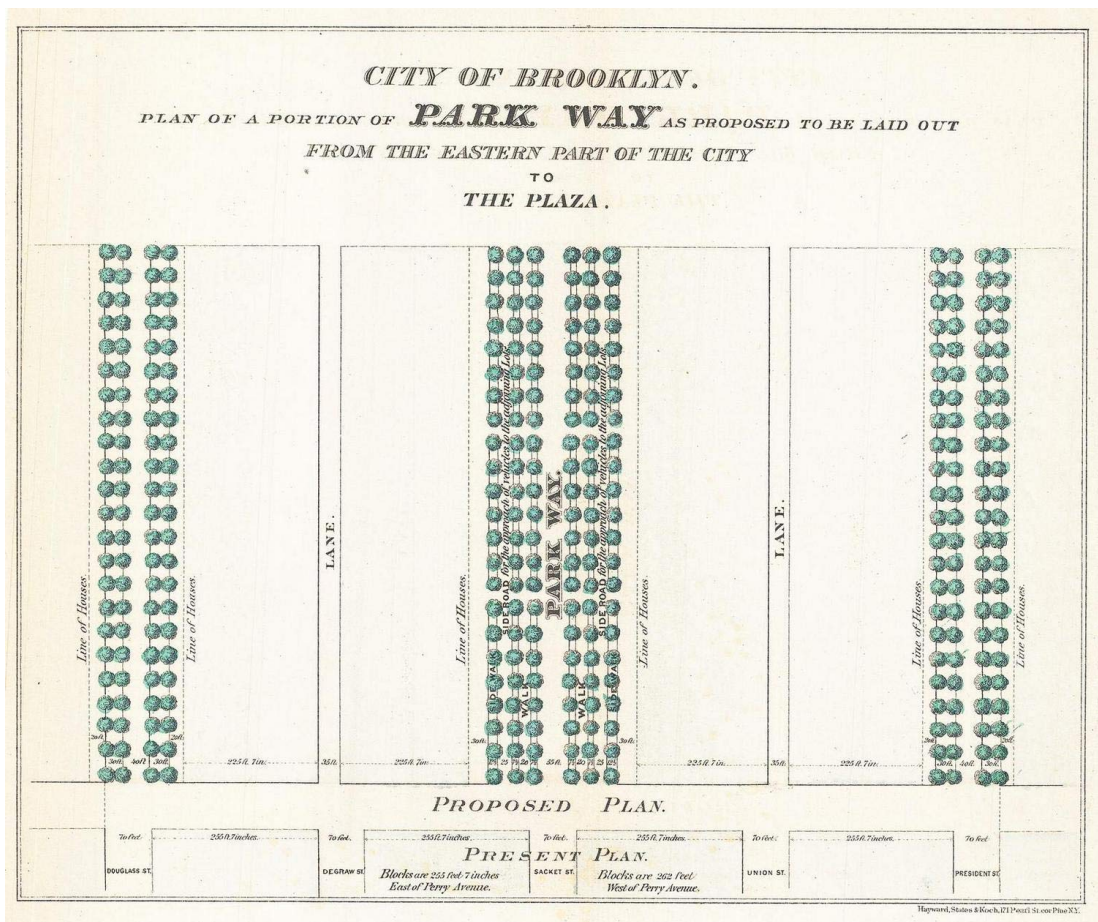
Plan d'une section de l'Eastern Parkway, Brooklyn, 1868
